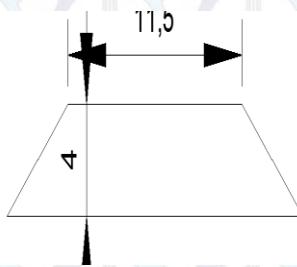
potongan melintang timbunan trapesium H= 8 m
